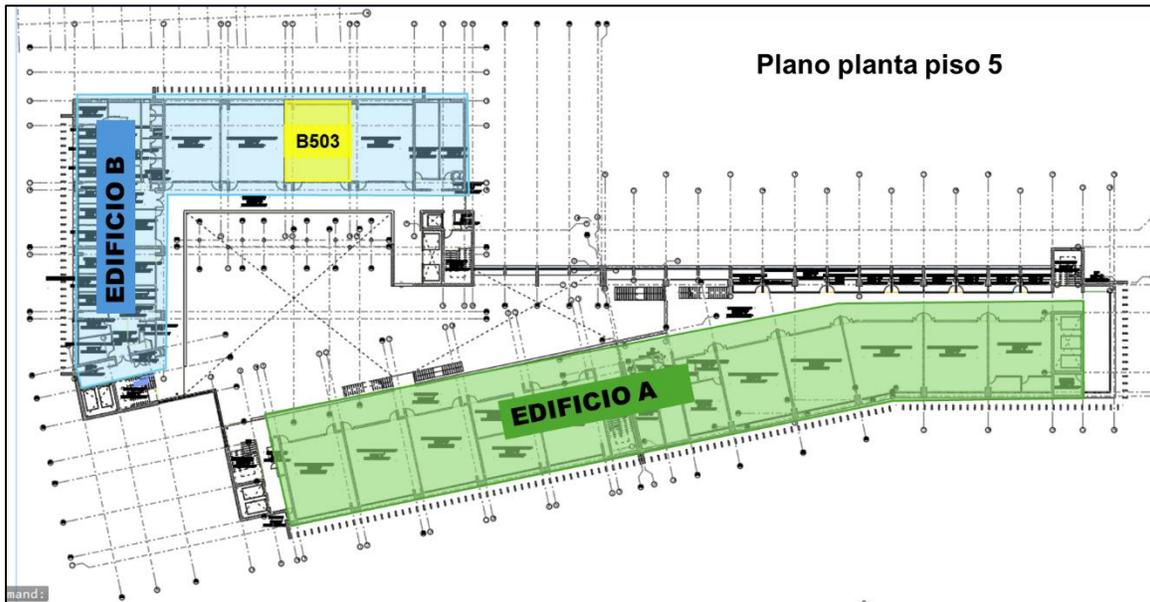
Plano general del piso 5 Sede Bellavista – AutoCAD
